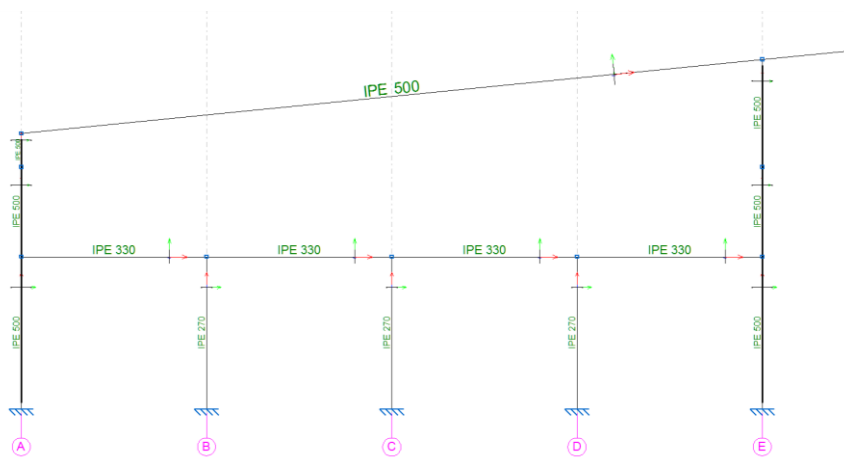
Pórtico interior de nave secundaria con detalle de perfiles
